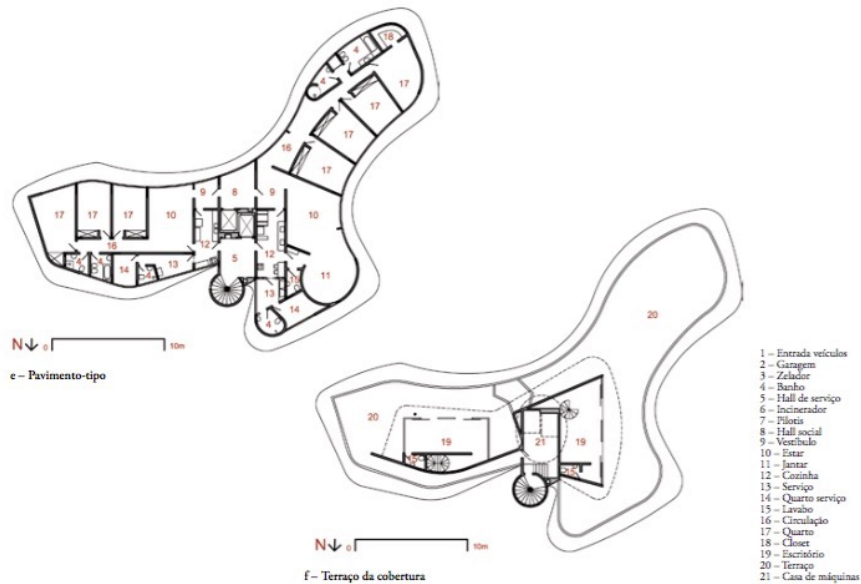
Edifício Niemeyer. Plantas do pav. tipo e o terraço da cobertura. FONTE: MATOSO, 2008.
